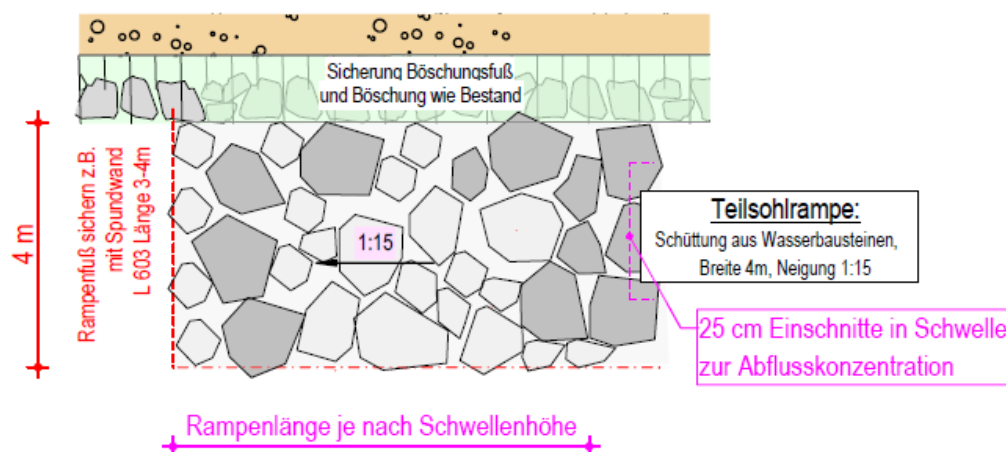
Detailplan Teilsohlrampen, Draufsicht
